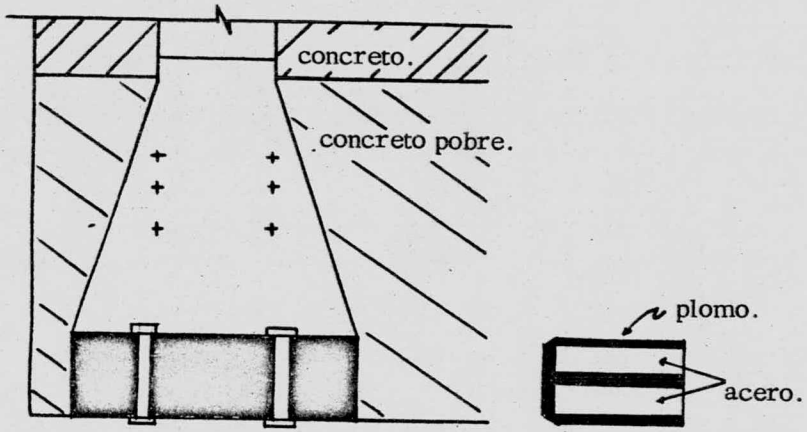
APOYO PARA ESTRUCTURA METALICA Y DETALLE DE PLACA.
